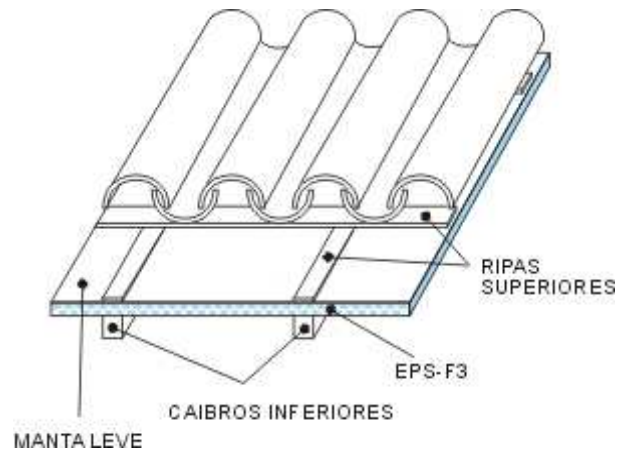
Isolamento térmico de telhados com telhas cerâmicas, telhas ou ardósia.
